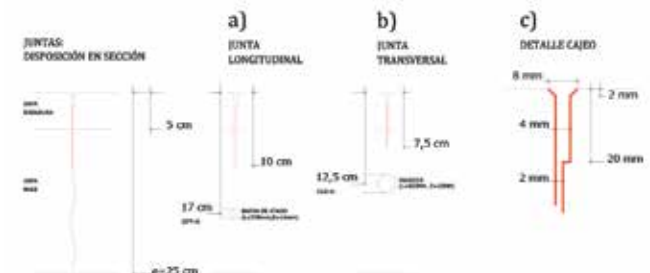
Juntas longitudinales (a), transversales (b), detalle de cajeo y biselado (c)
